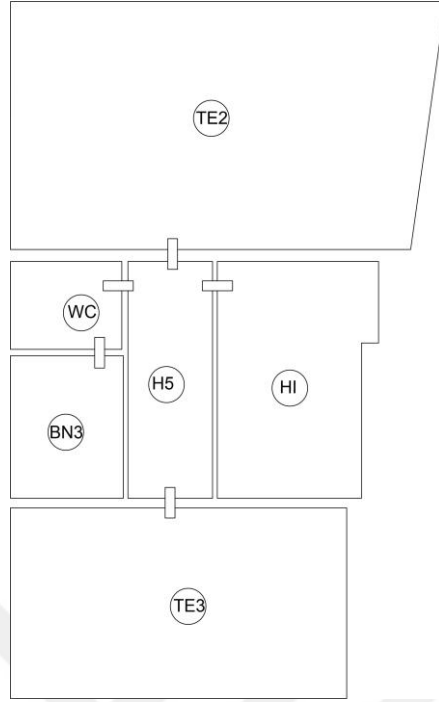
Şemsettin Sirer Yalısı giriş kat dışbükey planı
